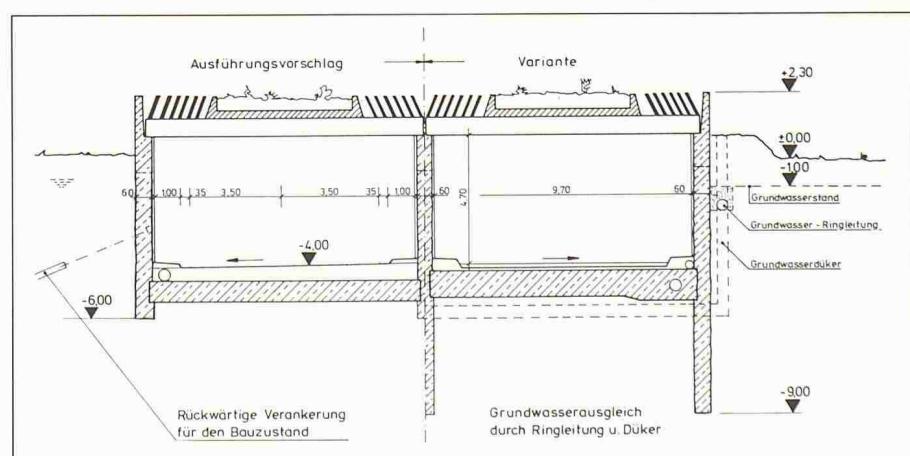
Lärmschutztunnel für die Bundesstrasse B 51, Umgehungsstrasse von Münster/Westf., mit Teilabdeckung, erbaut in offener Bauweise mit Schlitzwänden und Absenkung des Grundwasserspiegels (Voss)
